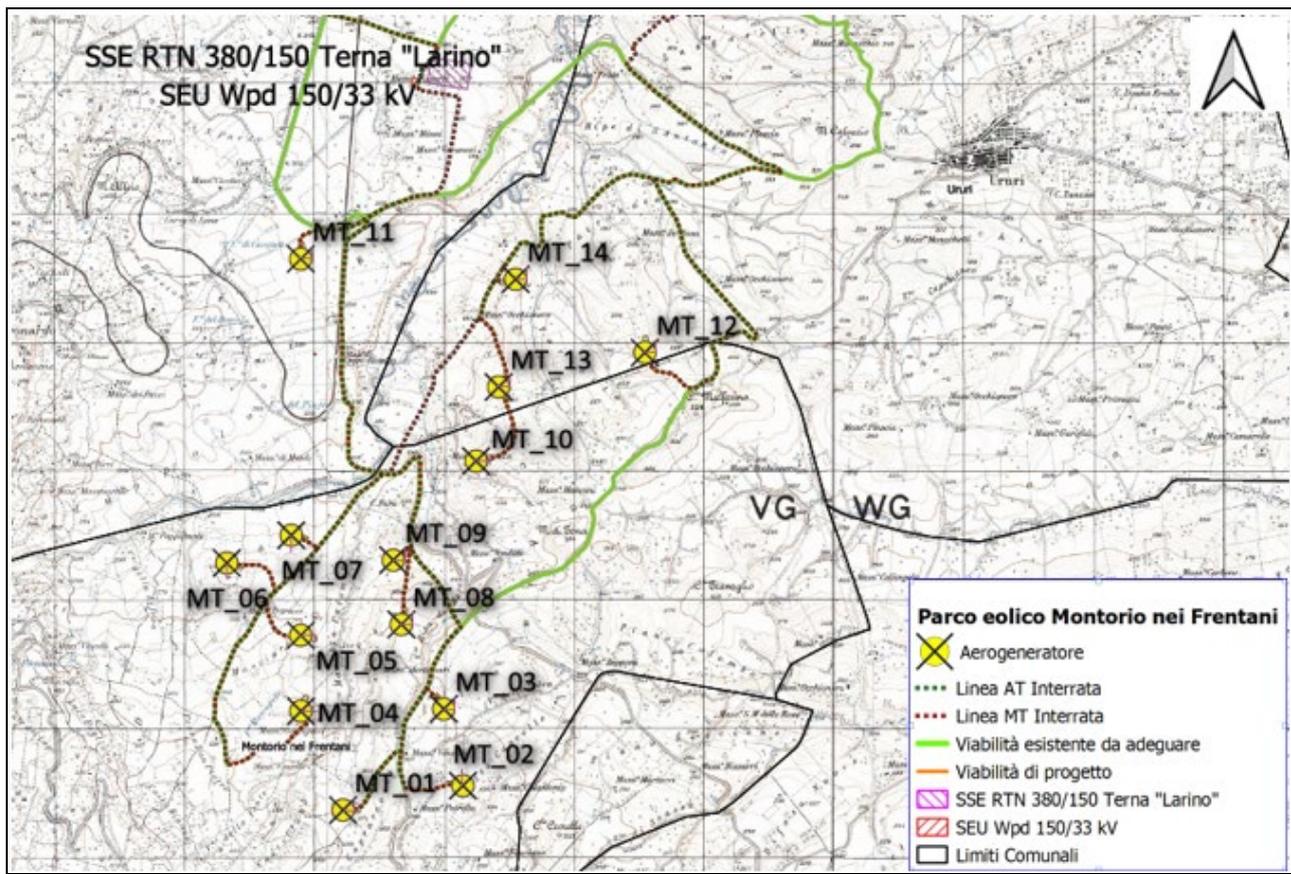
Layout d'impianto: Zona 2 su IGM
